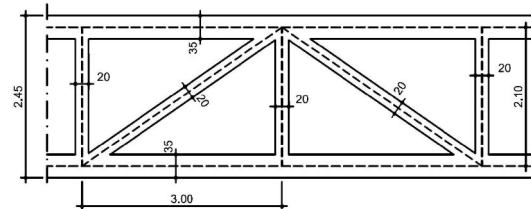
Adaptionsvariante L2.A: externe Fachwerkstruktur (Stahlbeton) plus Ergänzungsvorspannung
